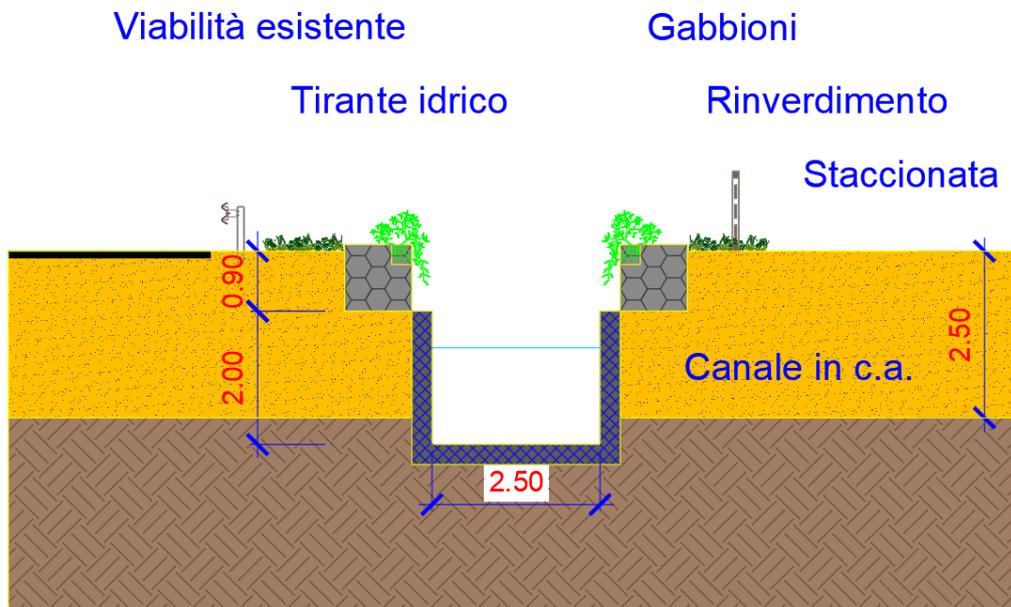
Sezione tipo del canale con scotolari aperti in c.a.
